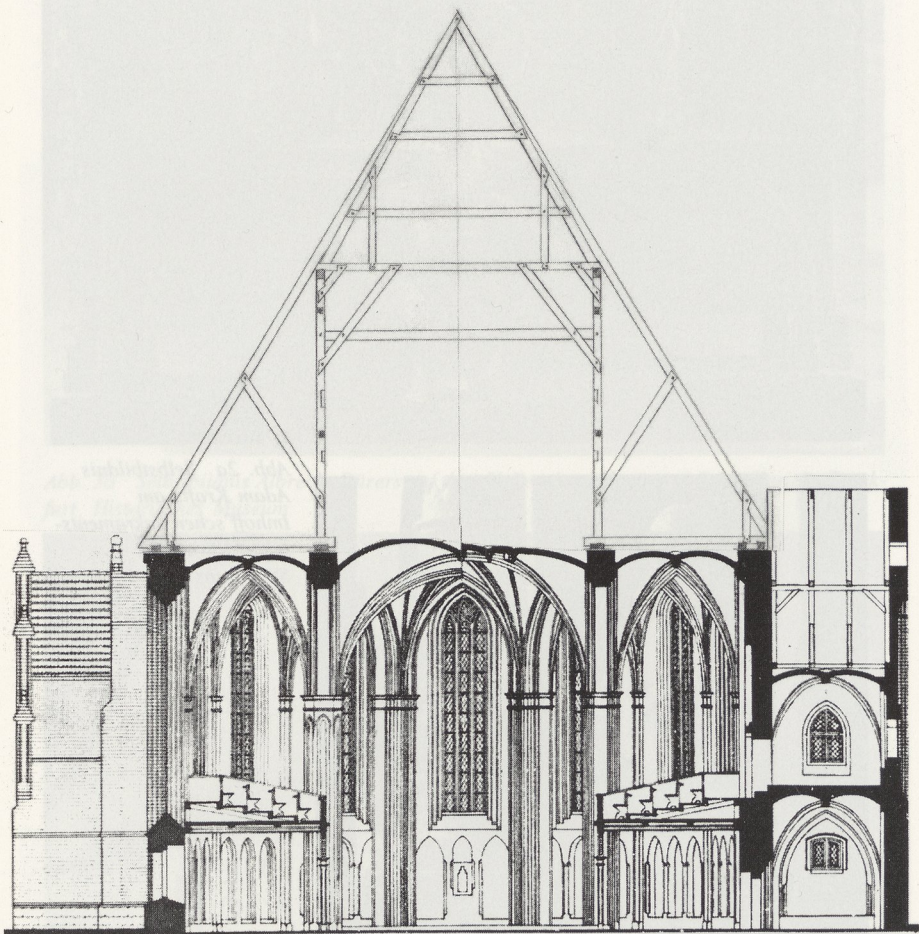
Berlin-Spandau, St. Nikolai. Querschnitt durch das Langhaus mit Dachwerk (schematische Bauaufnahme von 1883 nach Denkmälerinventar, Dachwerk korrigiert durch E. Rüschi)
